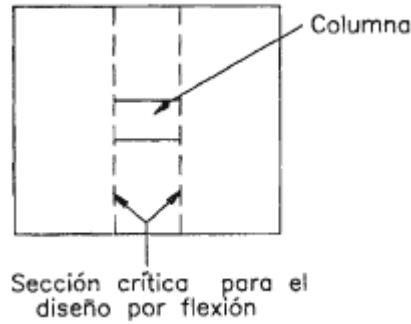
Sección crítica por flexión en zapatas aisladas (Harmsen, 2002)
